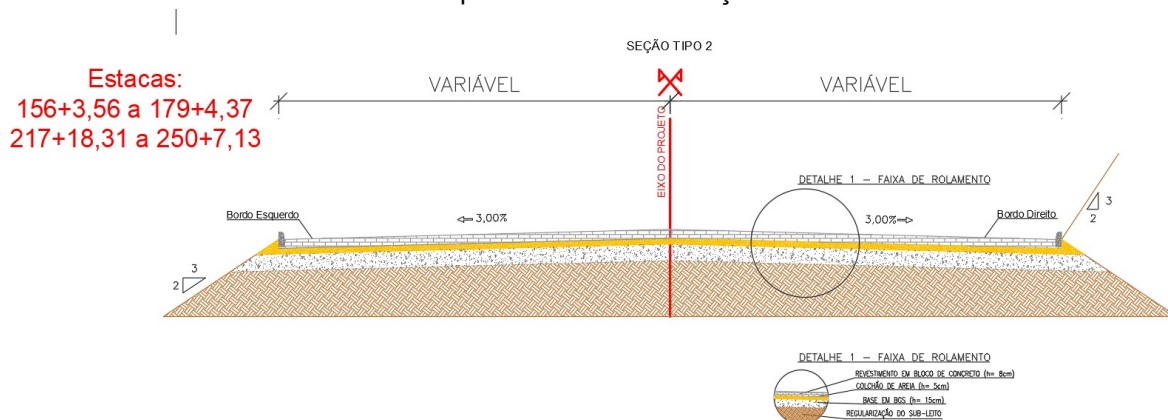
Seção geométrica do Trecho de pavimentação em blocos de concreto.
